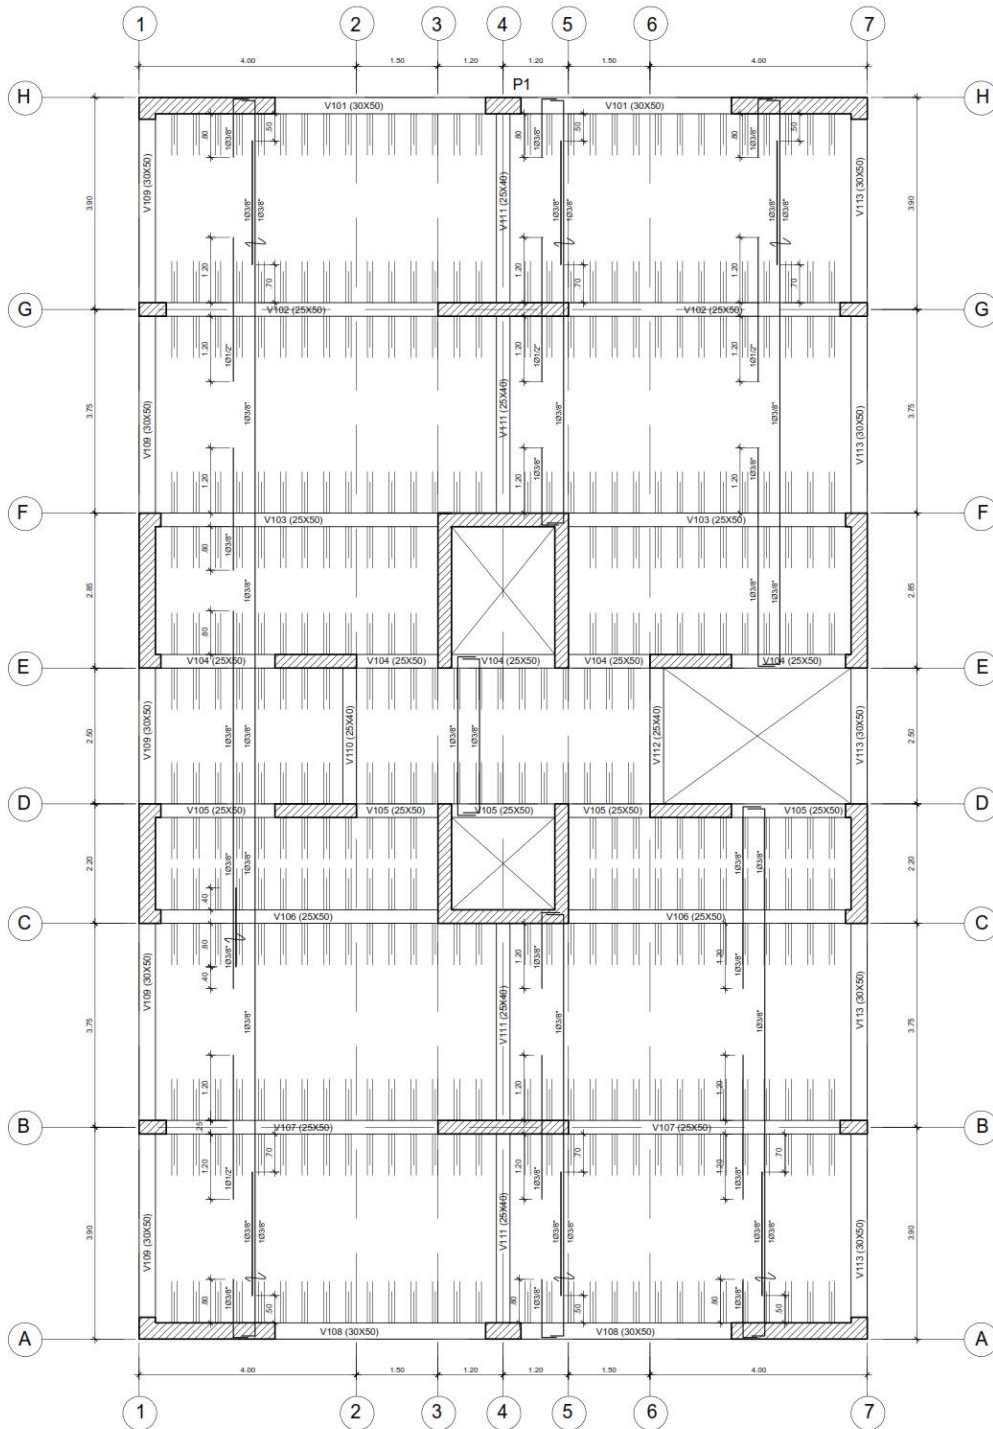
Refuerzo final en losa aligerada de edificación con disipadores
